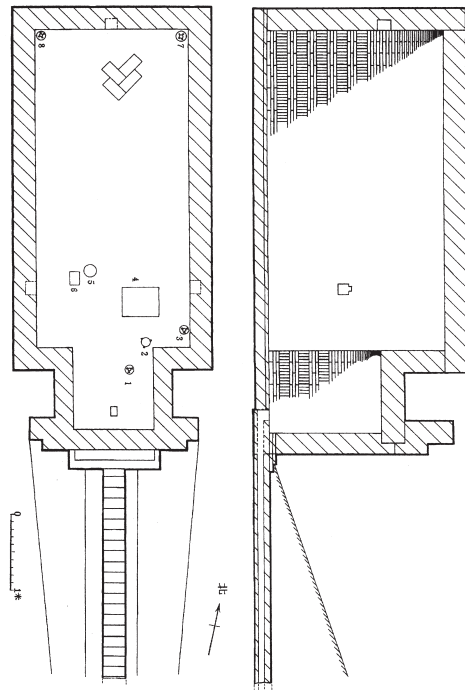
江苏省南京市东晋象山 M10 平·断面图 (1/100)
